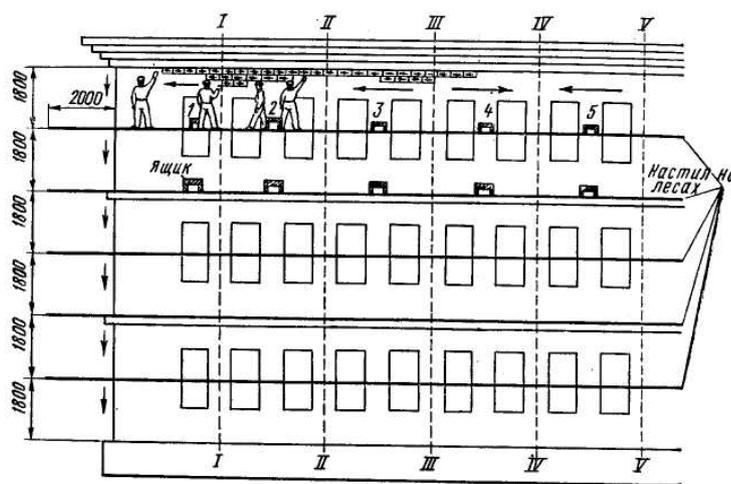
Оштукатуривание фасада захватками, идущими поэтажно
